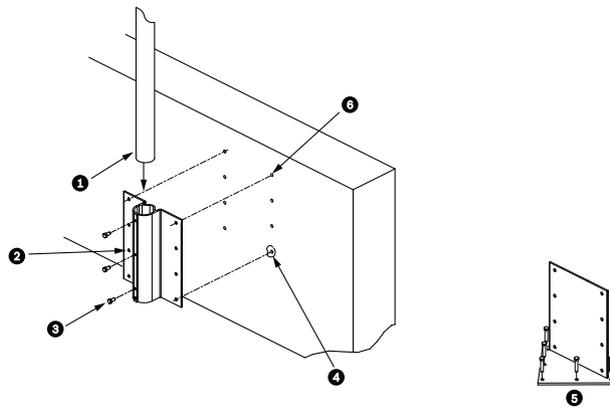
Support de montage parapet suspendu et platine de montage parapet
